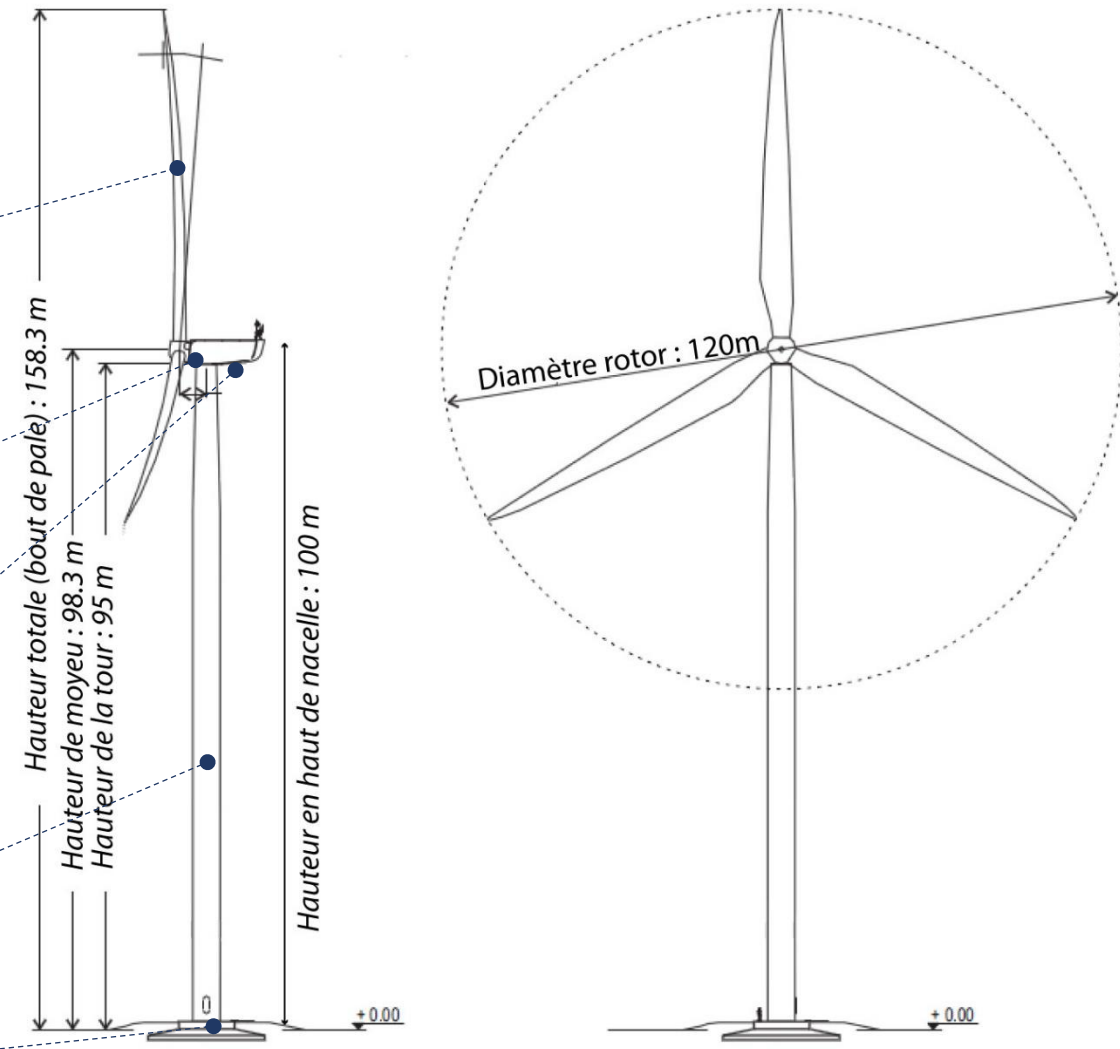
Plan d'élevation du gabarit-type d'éolienne prévu
